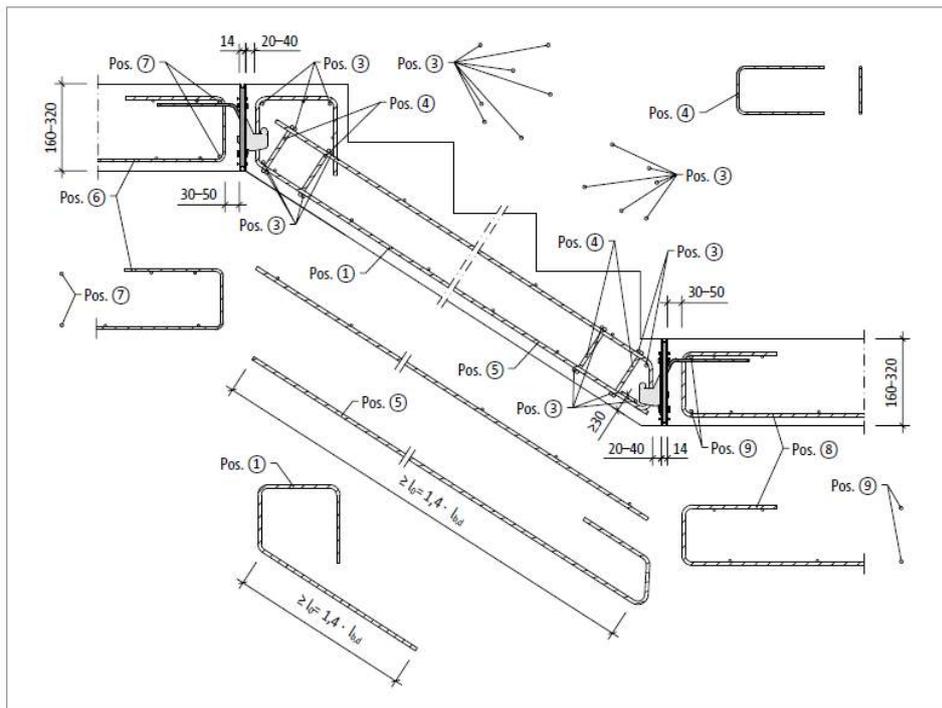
Schöck Tronsole® Typ T: Bauseitige Bewehrung
